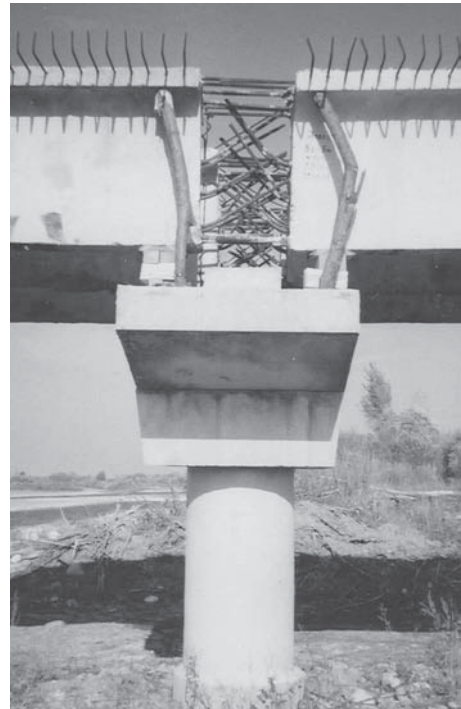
Проміжна опора з обпертими на тимчасові дерев'яні бруски балками суміжних прольотів і прямими і відігнутими випусками арматури з торців балок
